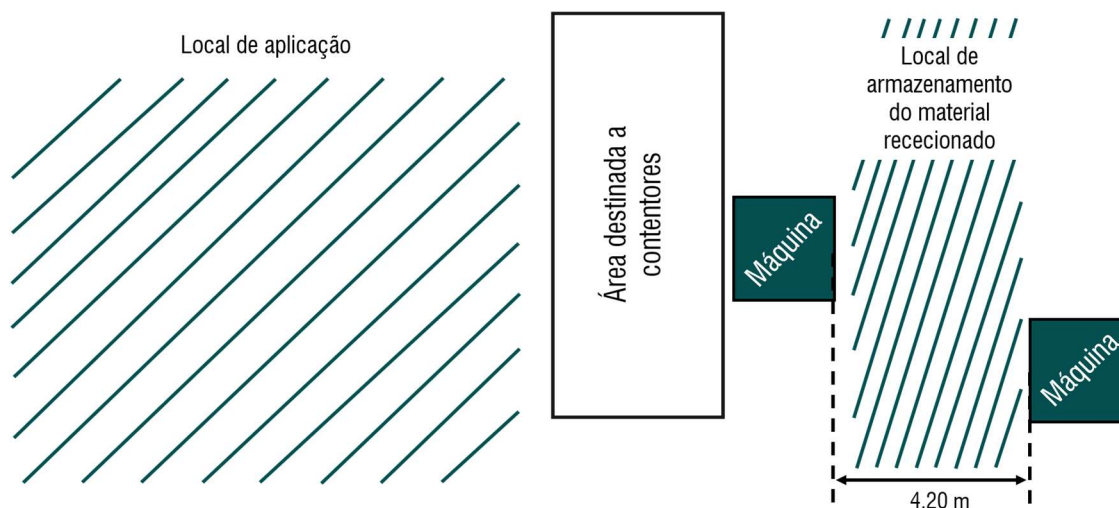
Layout* do estaleiro da 1ª obra em estudo
